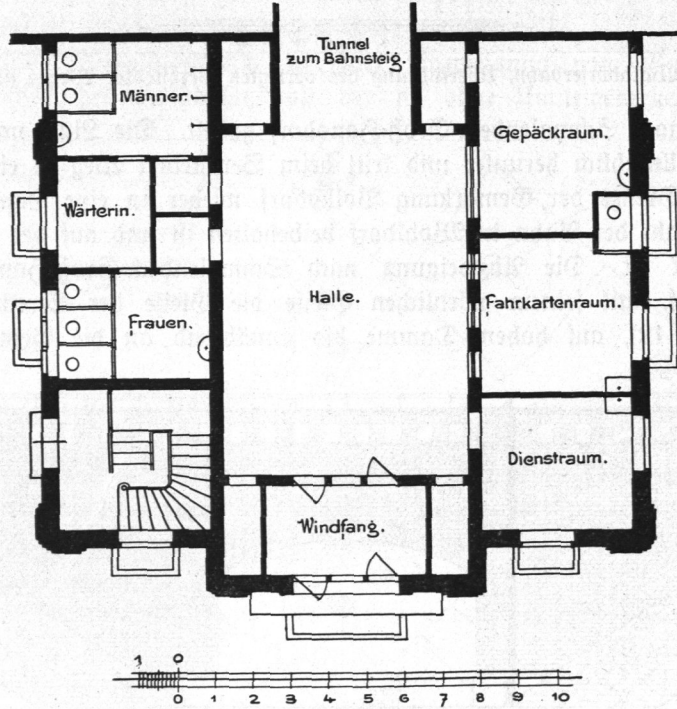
Haltestelle Habichtstraße, Erdgeschoss.
